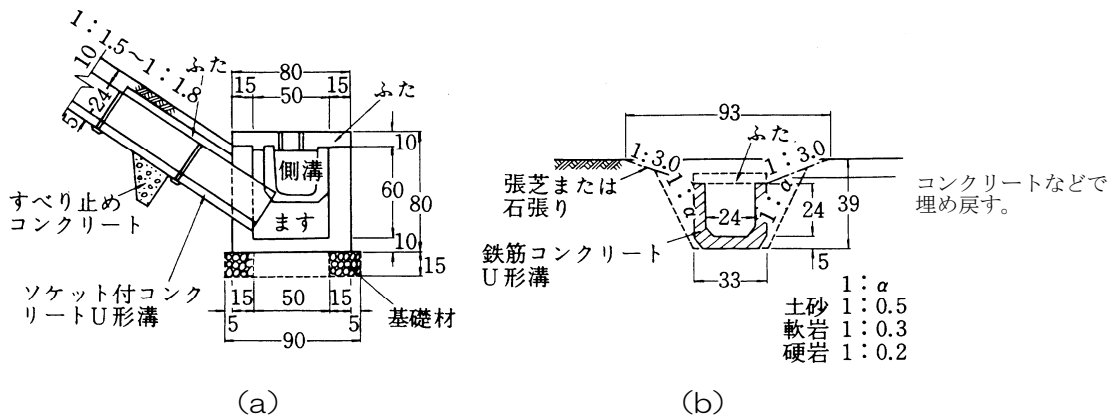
鉄筋コンクリートU形側溝による縦排水溝の例 (単位 cm)
